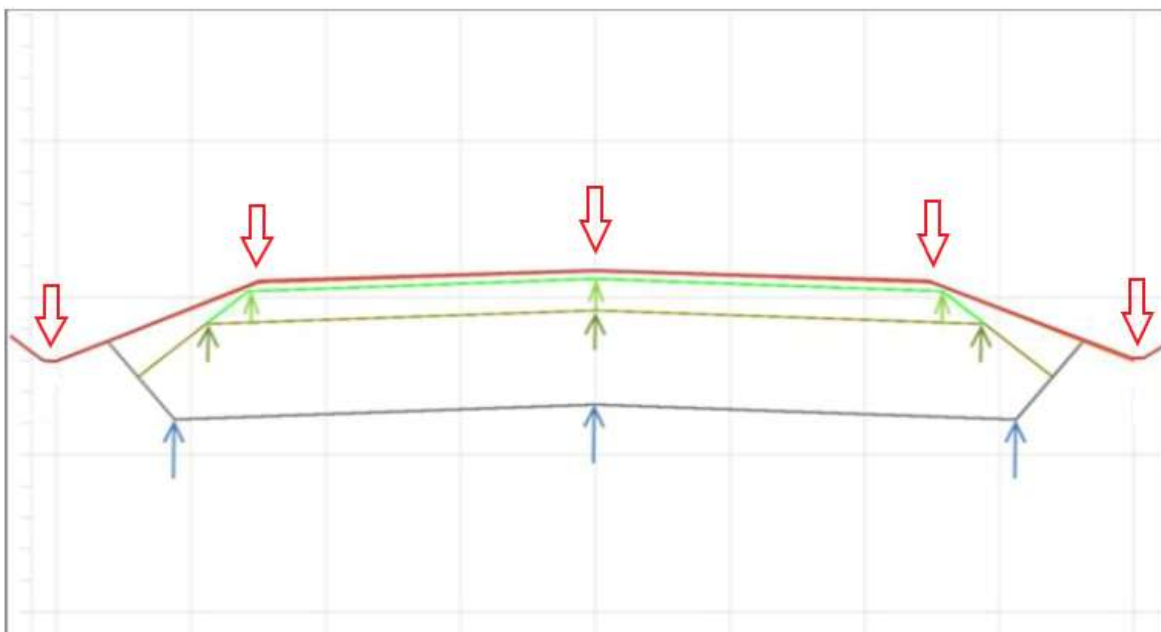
Illustration över en vägkonstruktion (buildingSMART, 2021c)
